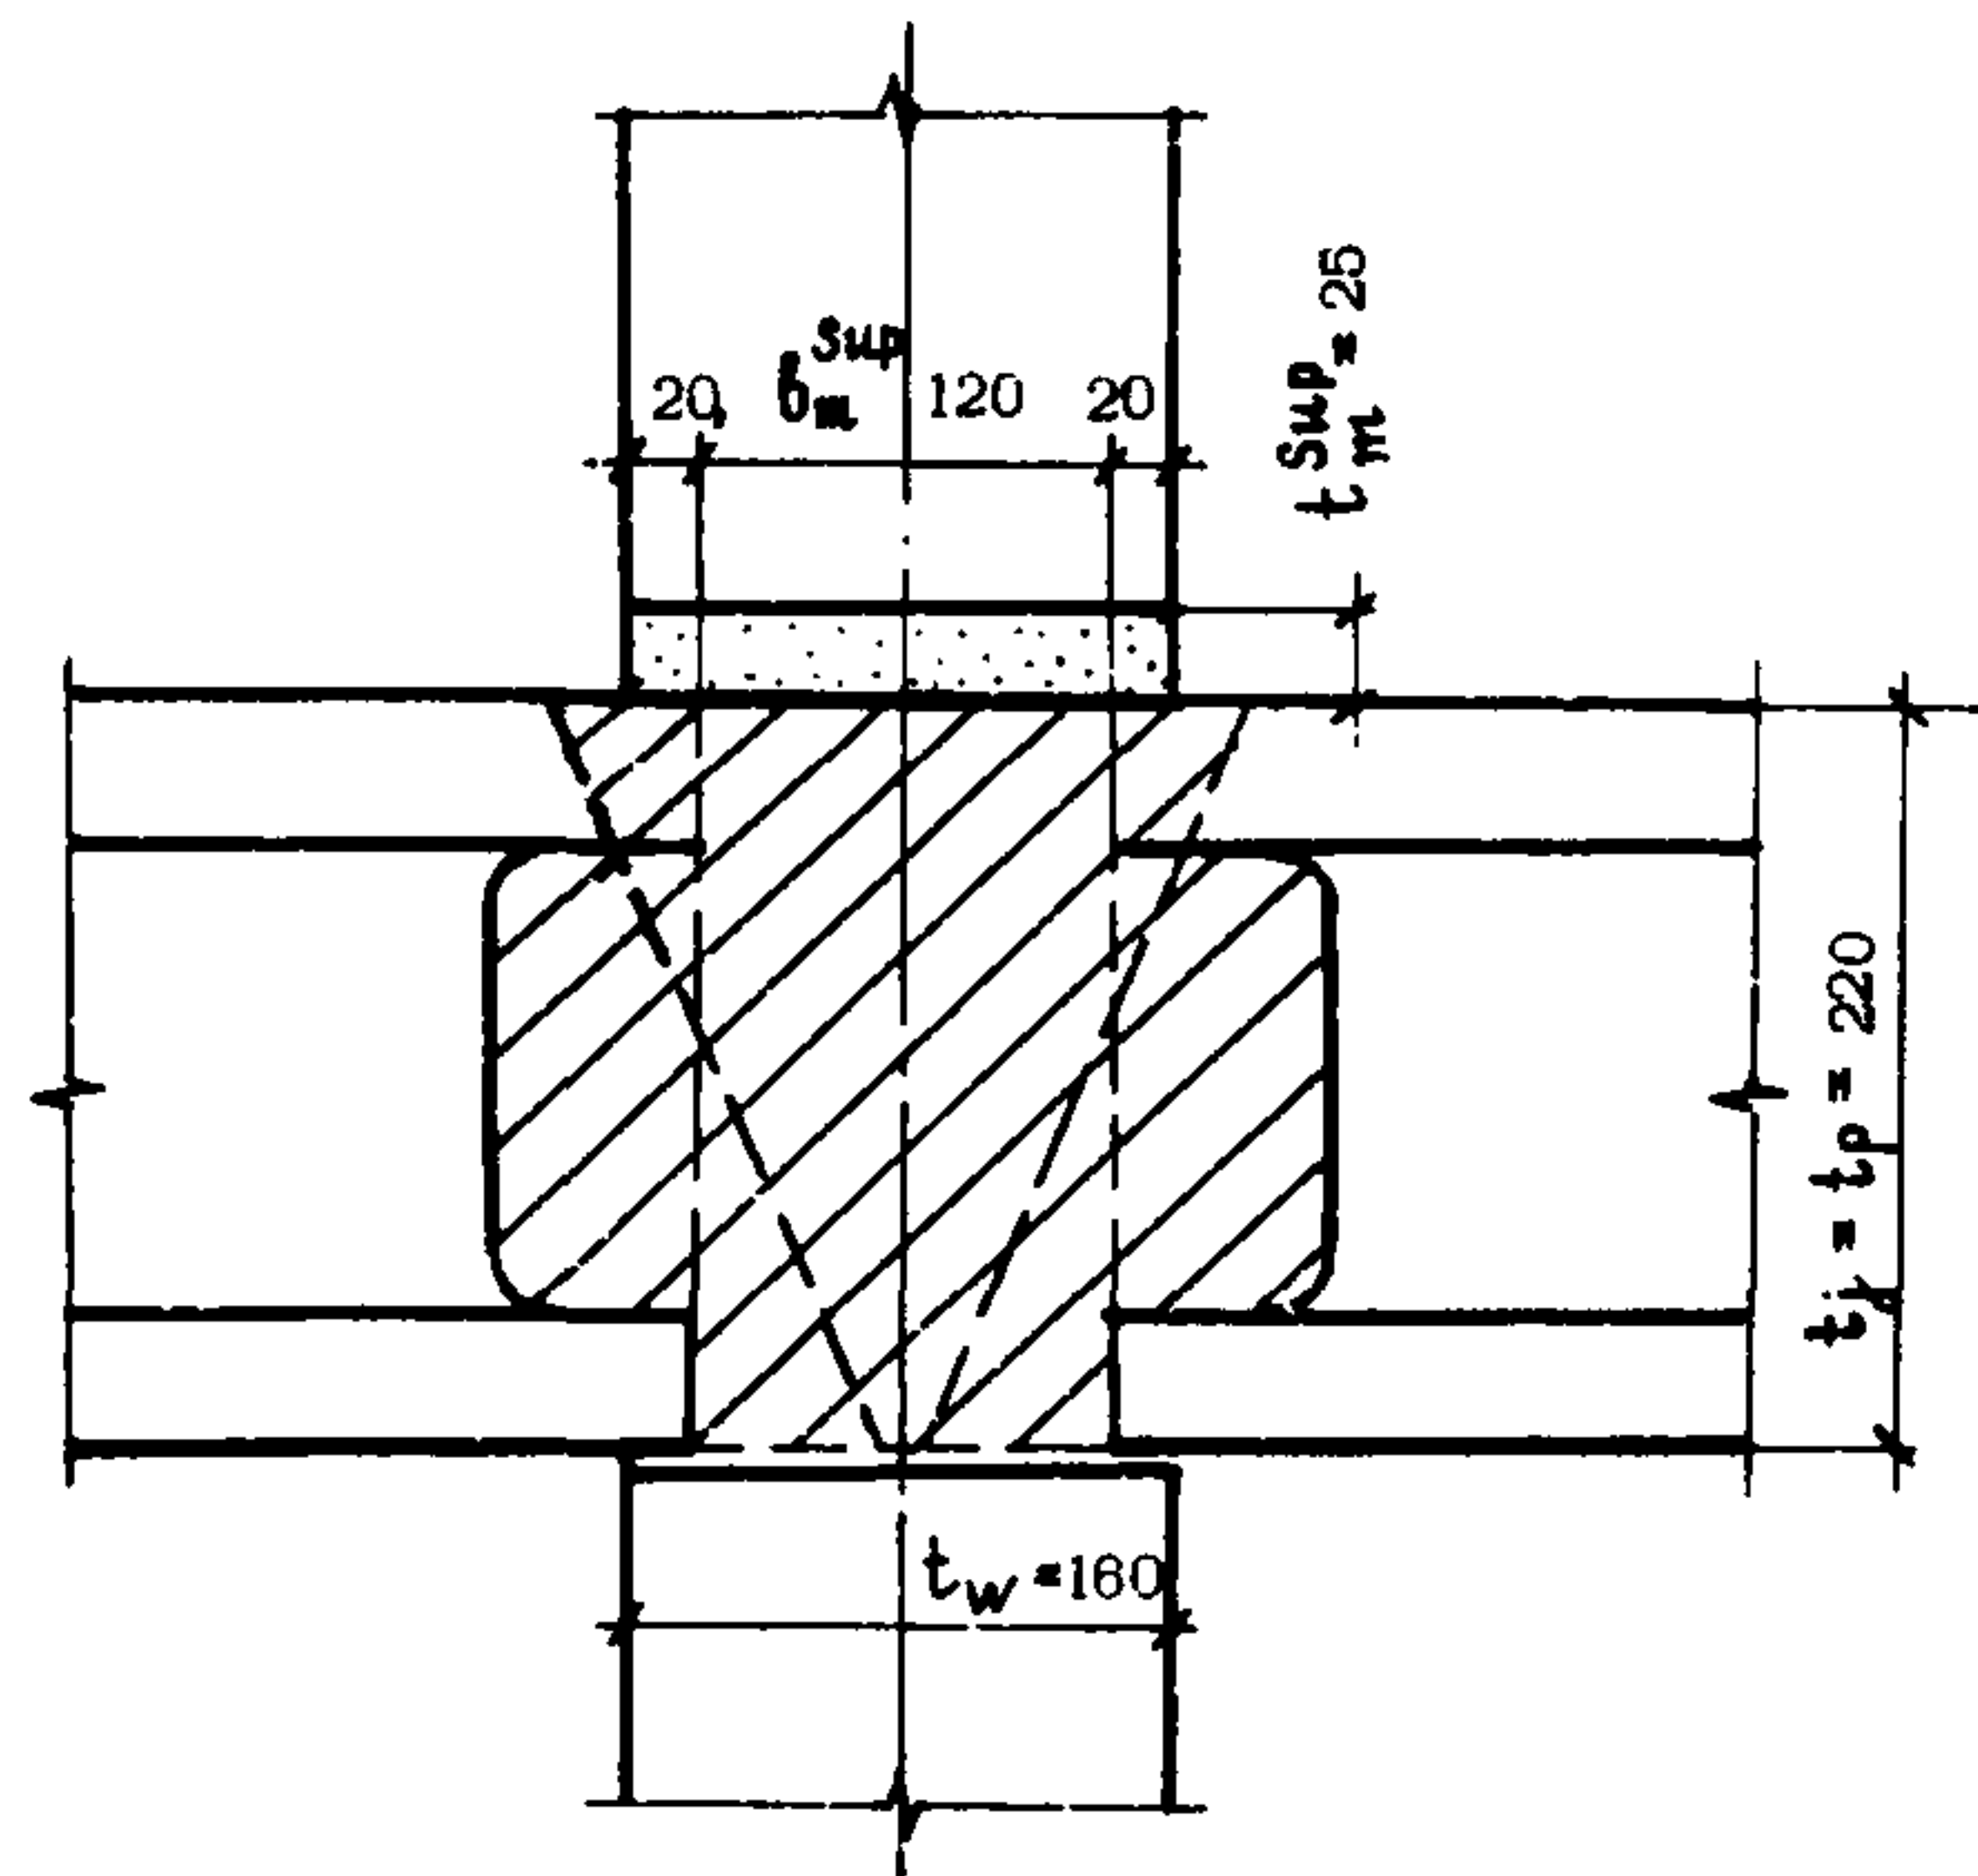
Монолитный стык внутренней панельной стены при двустороннем опирании плит перекрытий (к примеру 5)
